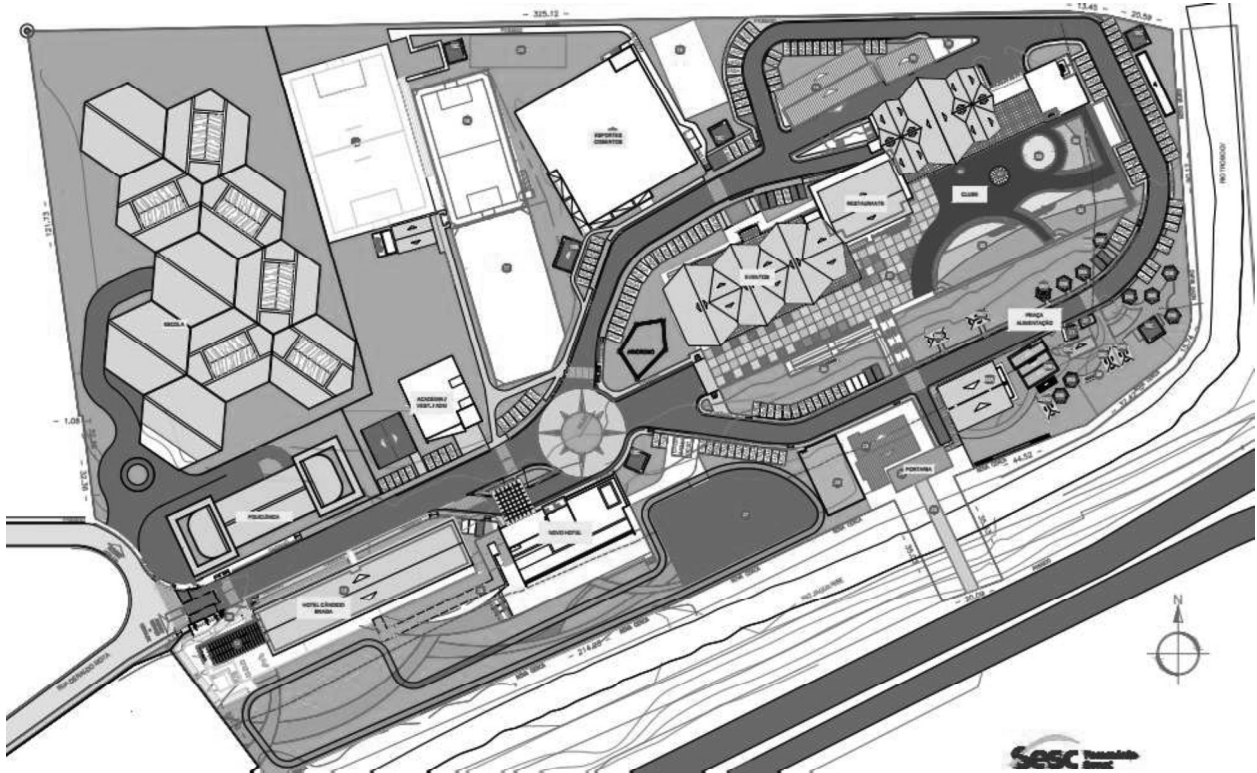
Planta de Situação Ilustrativa do Empreendimento
